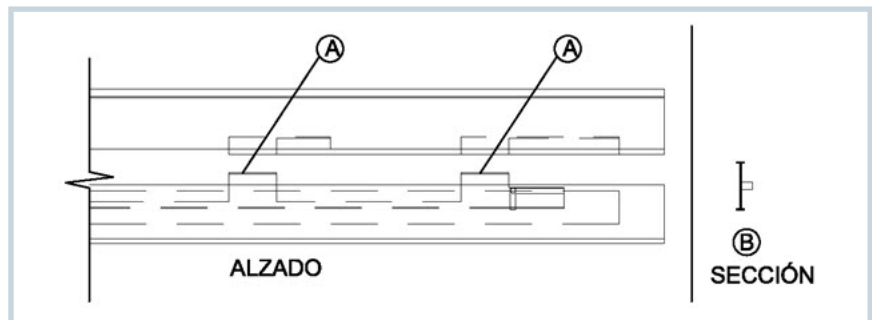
Sistema propuesto de unión de lamas en alzado y sección.
